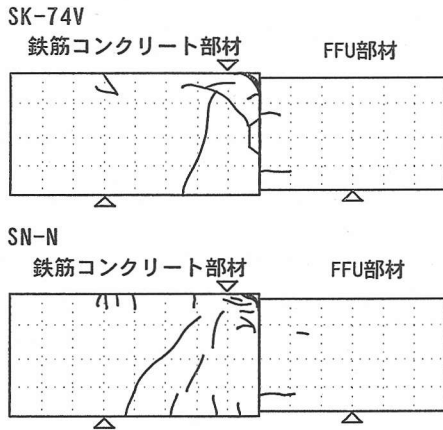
曲げせん断試験体の最終ひび割れ状況
